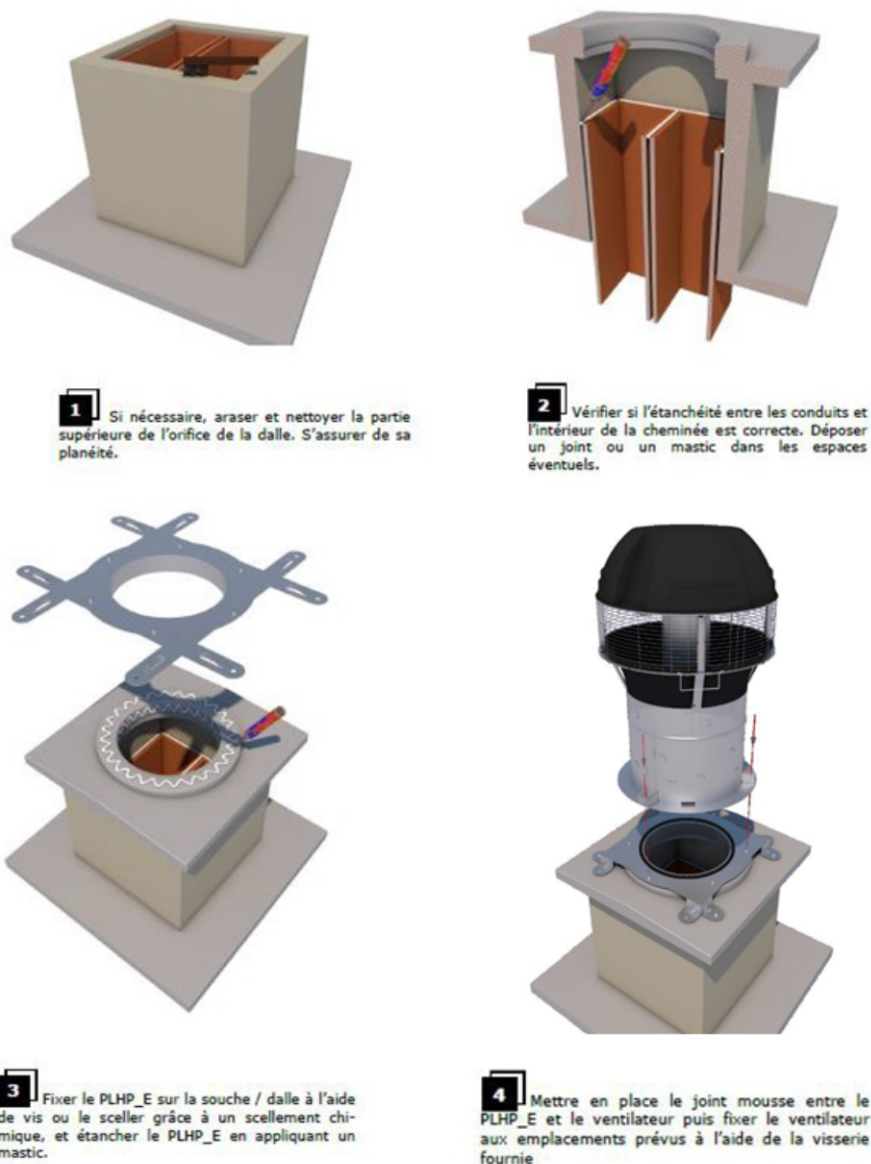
Mise en œuvre du ventilateur - Cas d'un conduit existant avec dalle conservée
